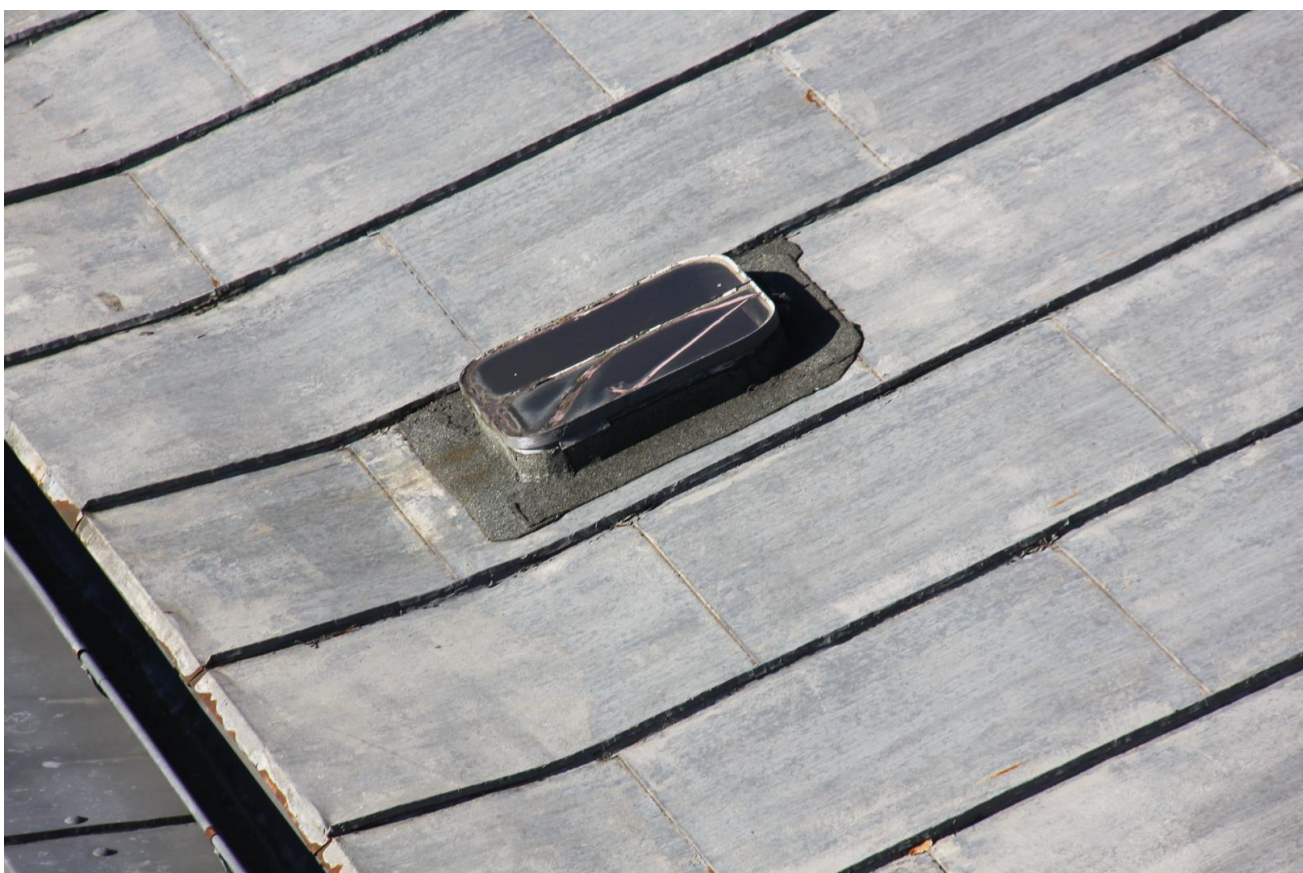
Stan zachowania pokrycia dachowego. Naroże z nieprawidłowo wykonanym przeciwspadkiem –miejsce występowania uszkodzenia nr 4 więźby dachowej (brak kozubka).
